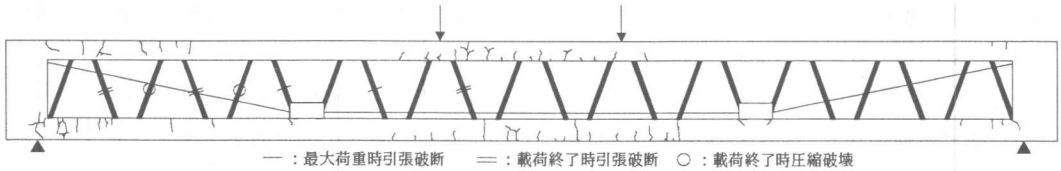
供試体のひび割れおよび斜材の破壊状況図 (軽量コンクリート)
